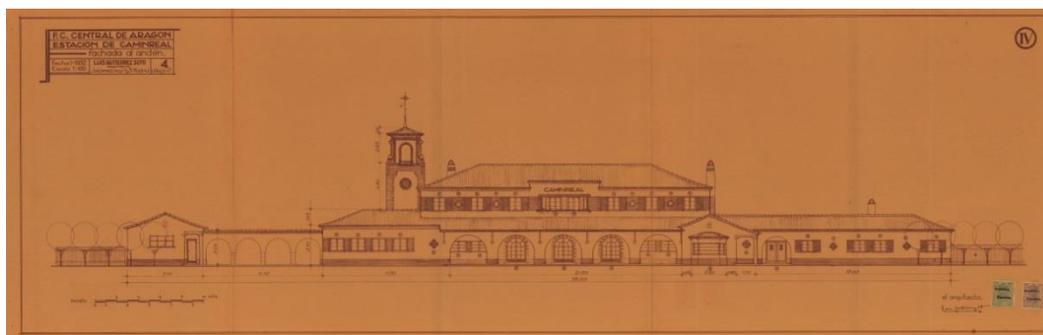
Alzado Principal de la estación de Caminreal. Plano de proyecto. (Fuente: Archivo AHF, 1932)
